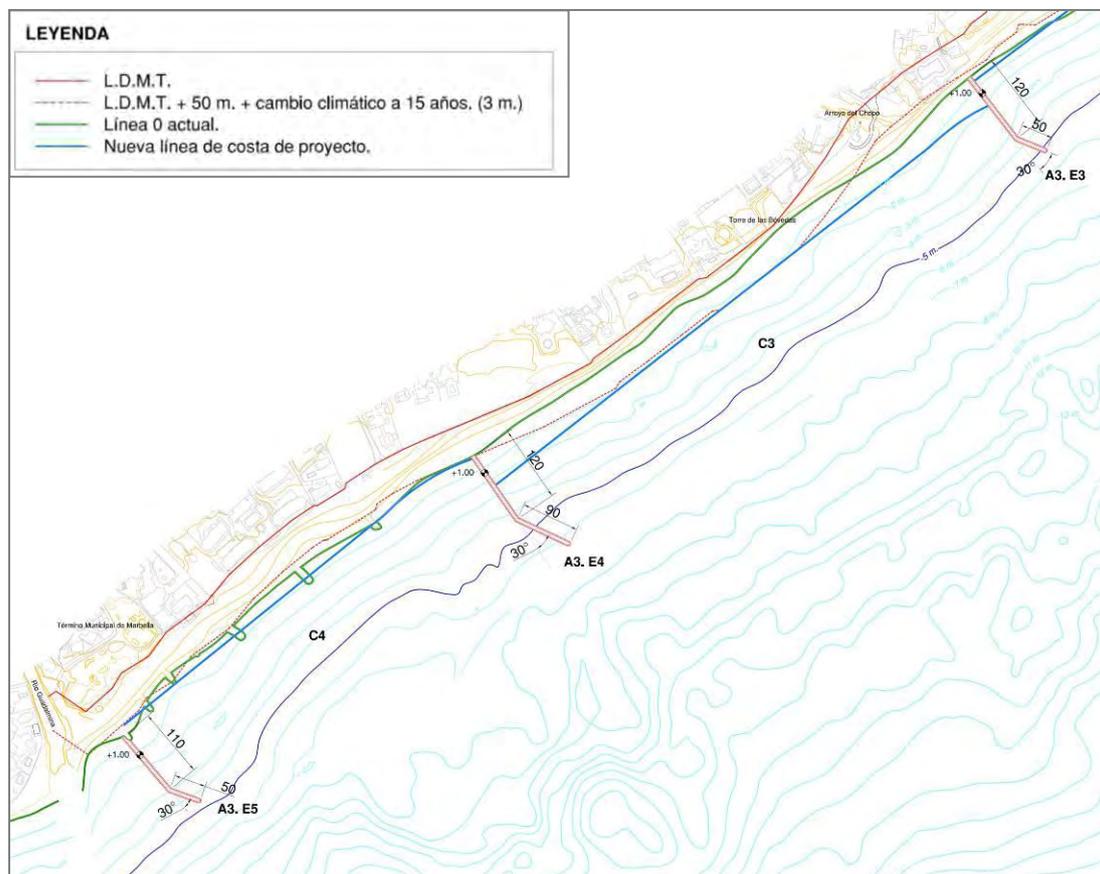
Planta Alternativa 3. Celdas C3-C4.
